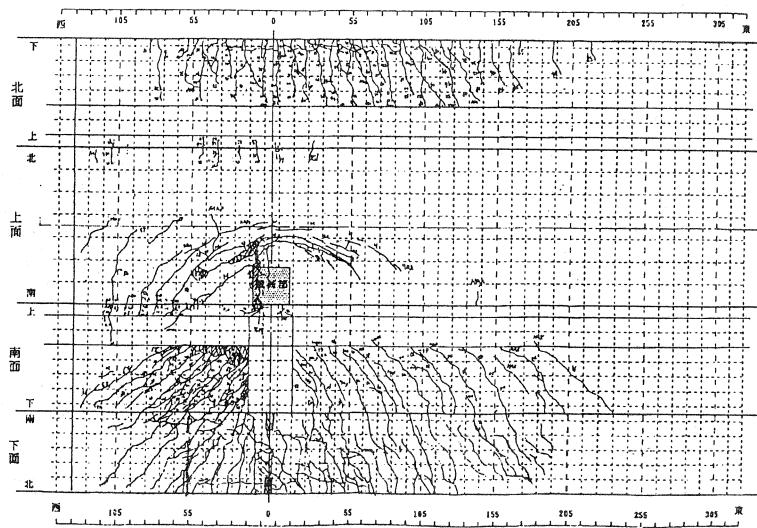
曲げねじり試験、ひび割れ発生状況
